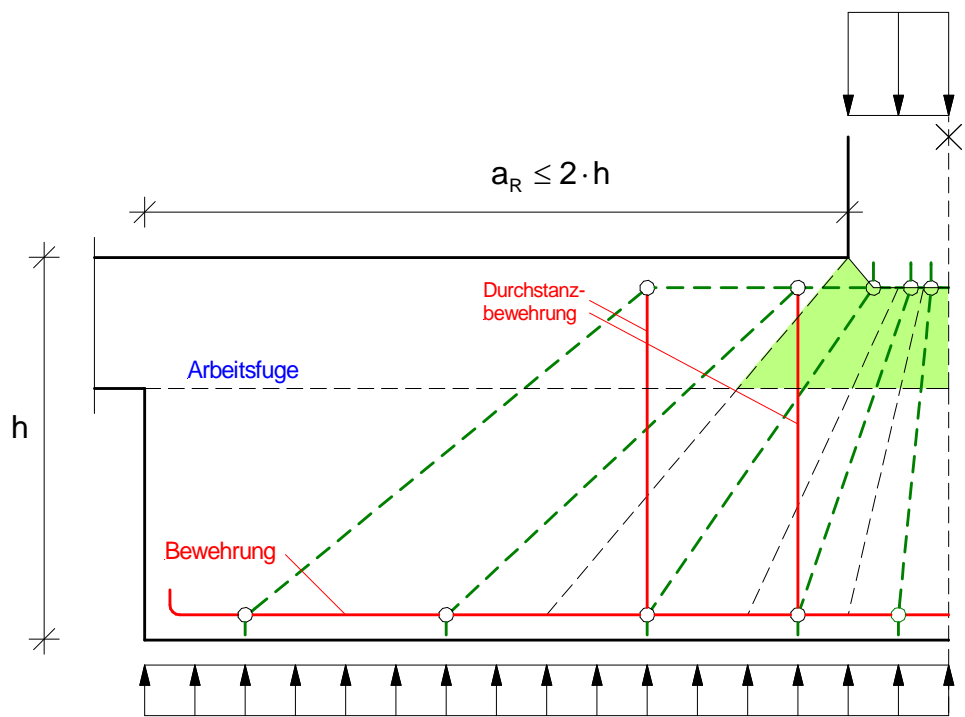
Gedrungenes Fundament mit $a_R / h \leq \approx 2$ mit Durchstanzbewehrung
